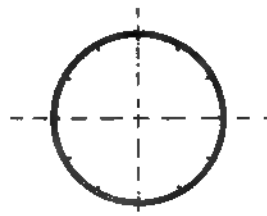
Stahlgerippe zu den Betonröhren, System Bonna.
